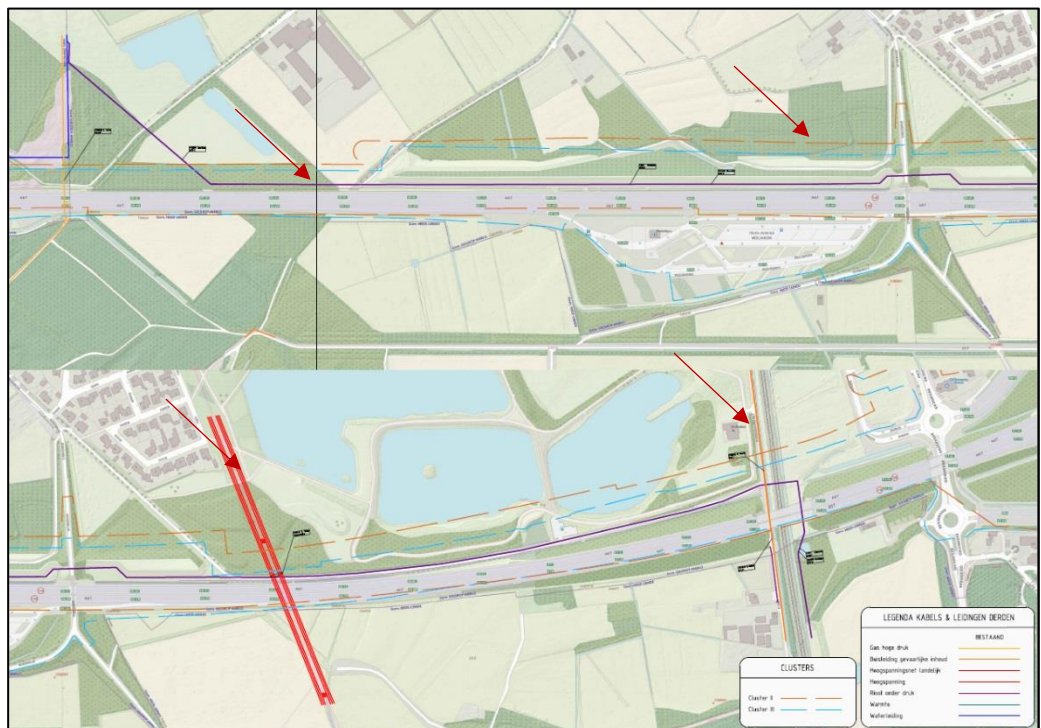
uitsnede halve Haarlemmermeeraansluiting alternatief 2 en 3
